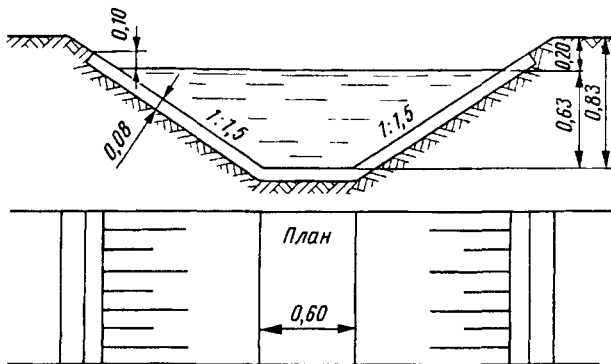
Поперечный профиль канавы с укреплением железобетонными секциями.
